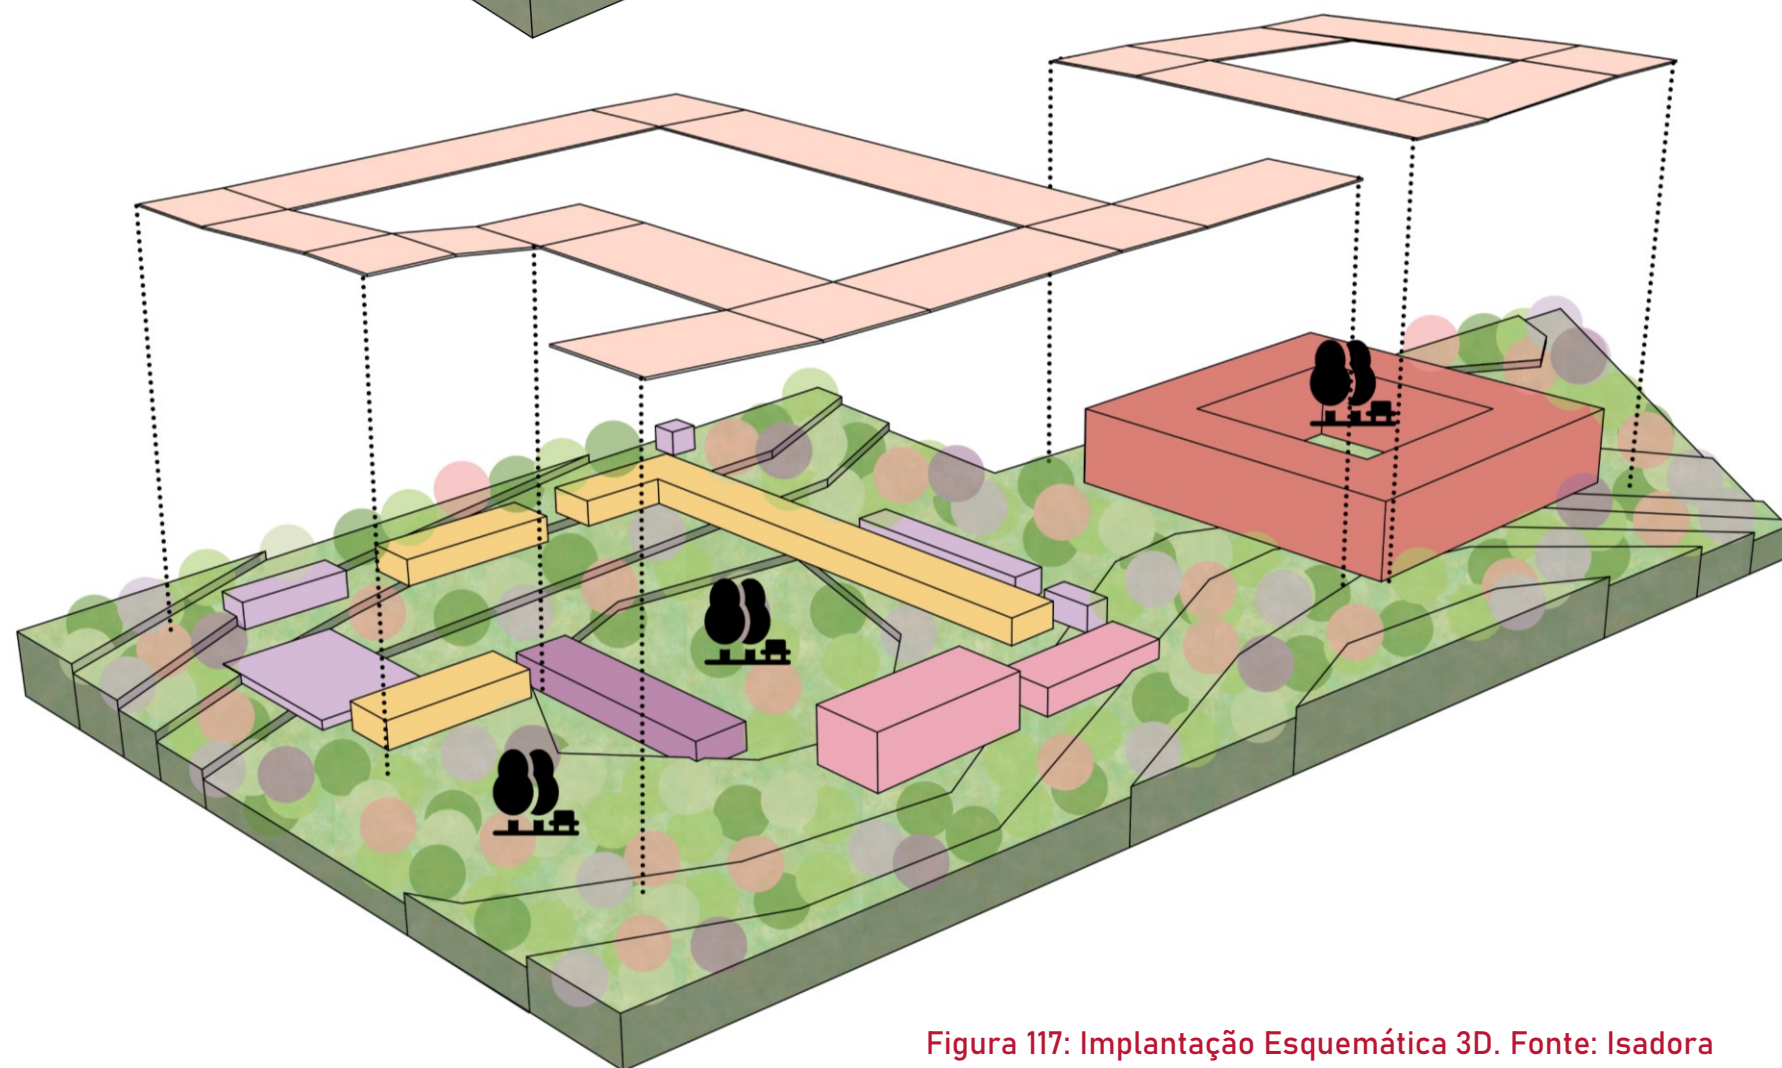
Implantação Esquemática 3D. Fonte: Isadora Benaion
